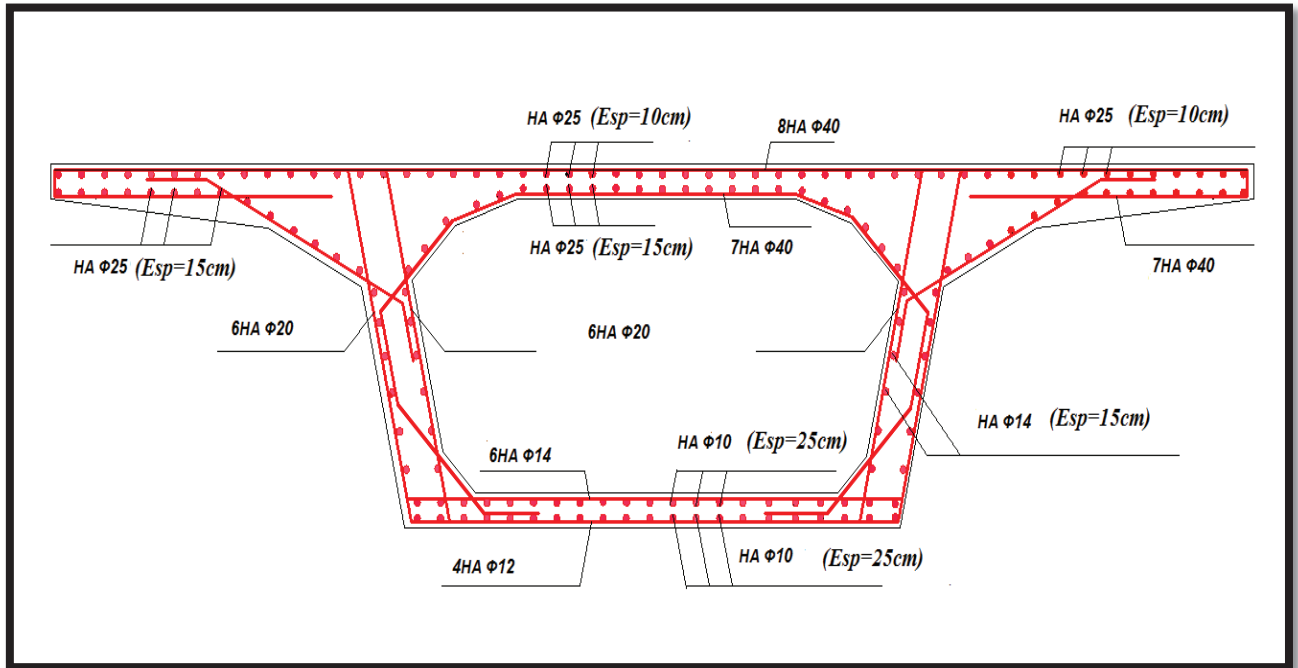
Schéma du Ferrailage du voussoir près de la clé.
